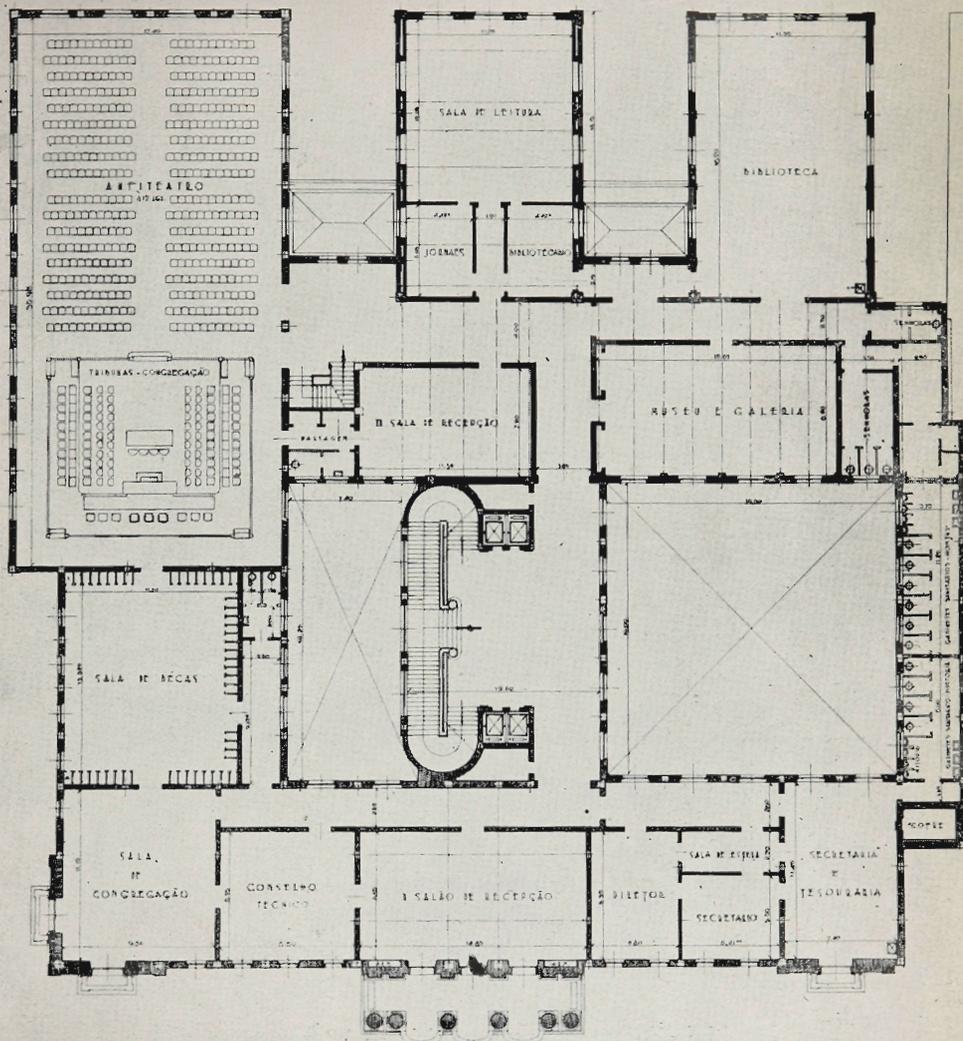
Planta do novo edificio — 2.º pavimento.
